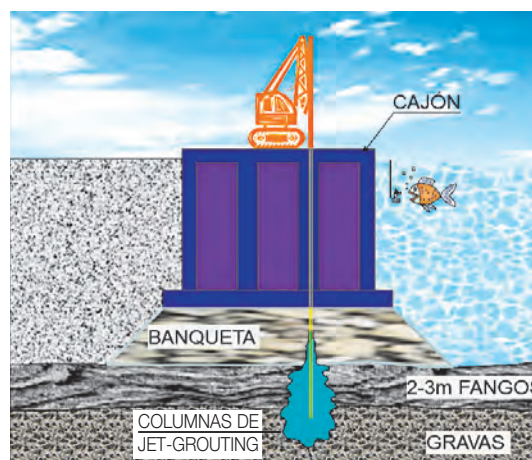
EJECUCIÓN DE LAS COLUMNAS DE JET-GROUTING.
